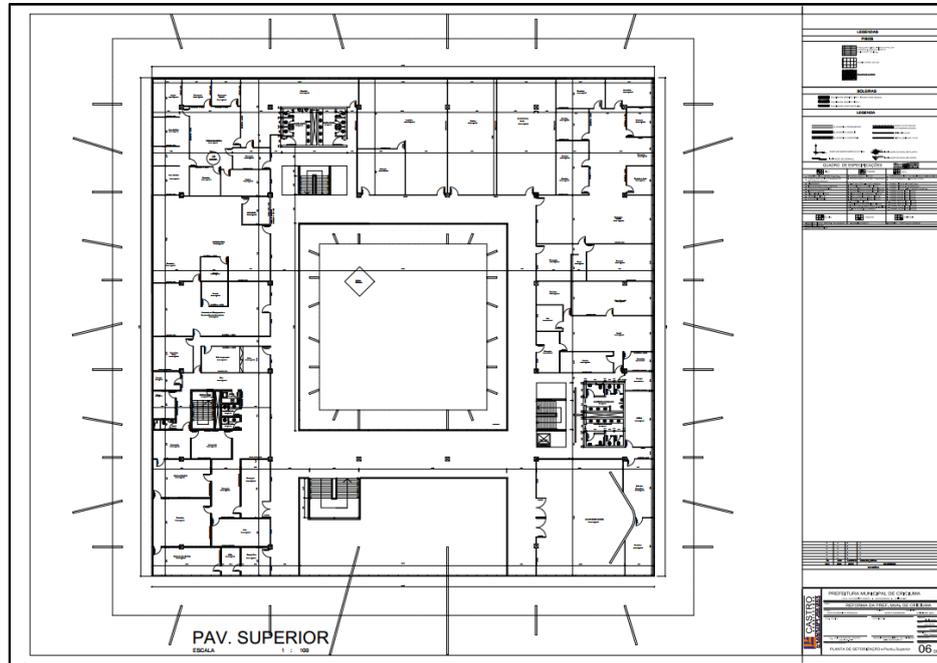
Planta baixa pavimento superior. (Fonte: PMC)
